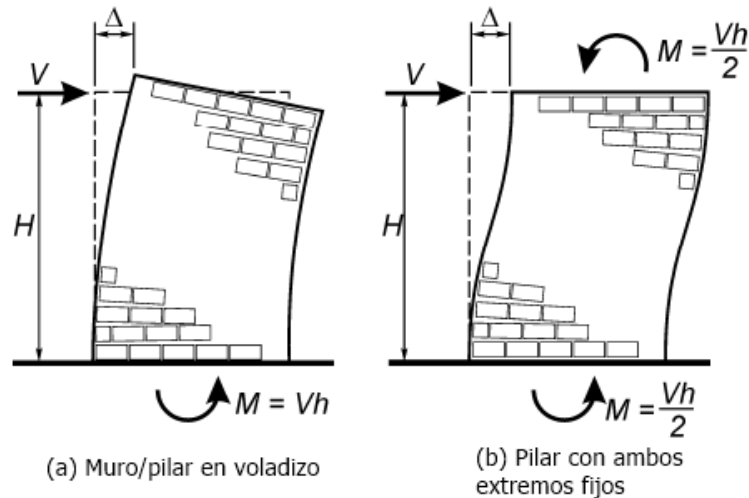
Condiciones de borde para muros, sub-muros y pilares
